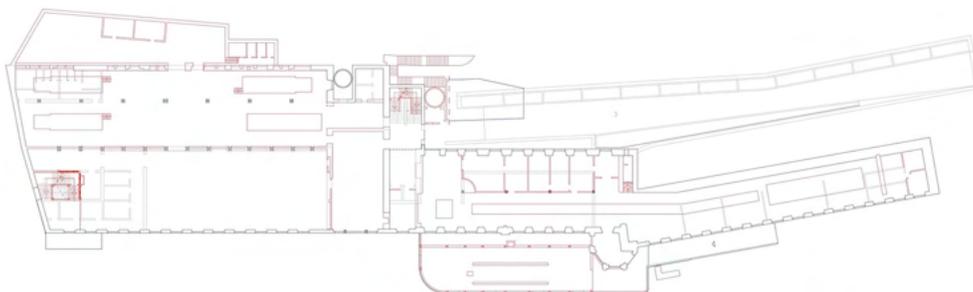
Planta existente do piso 1. A vermelho as alterações propostas.
